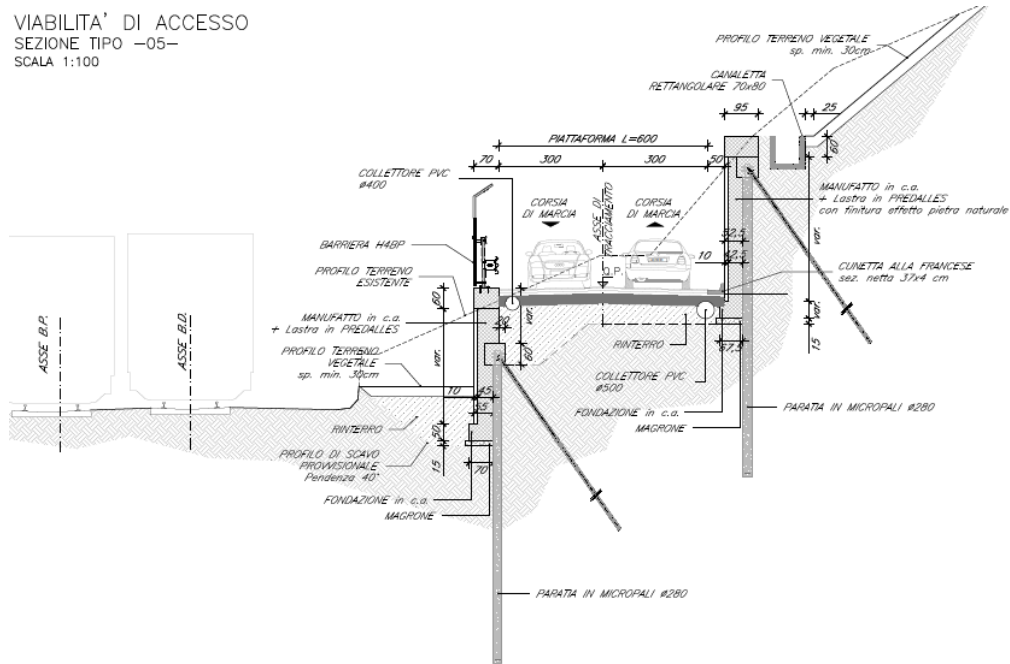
Viabilità di accesso – Sezione tipologica 5
